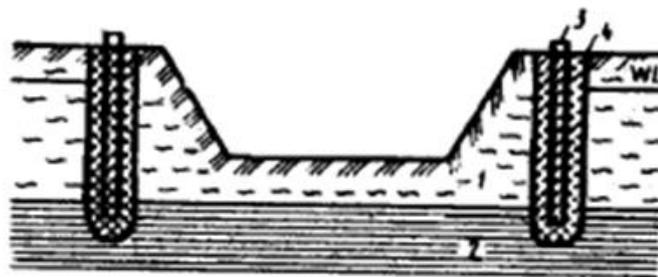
Схема защиты котлована от затопления подземными водами при помощи замораживания: 1 – водоносный слой грунта; 2 – водоупорный слой грунта; 3 – замораживающая колонка; 4 – цилиндр мерзлого грунта
